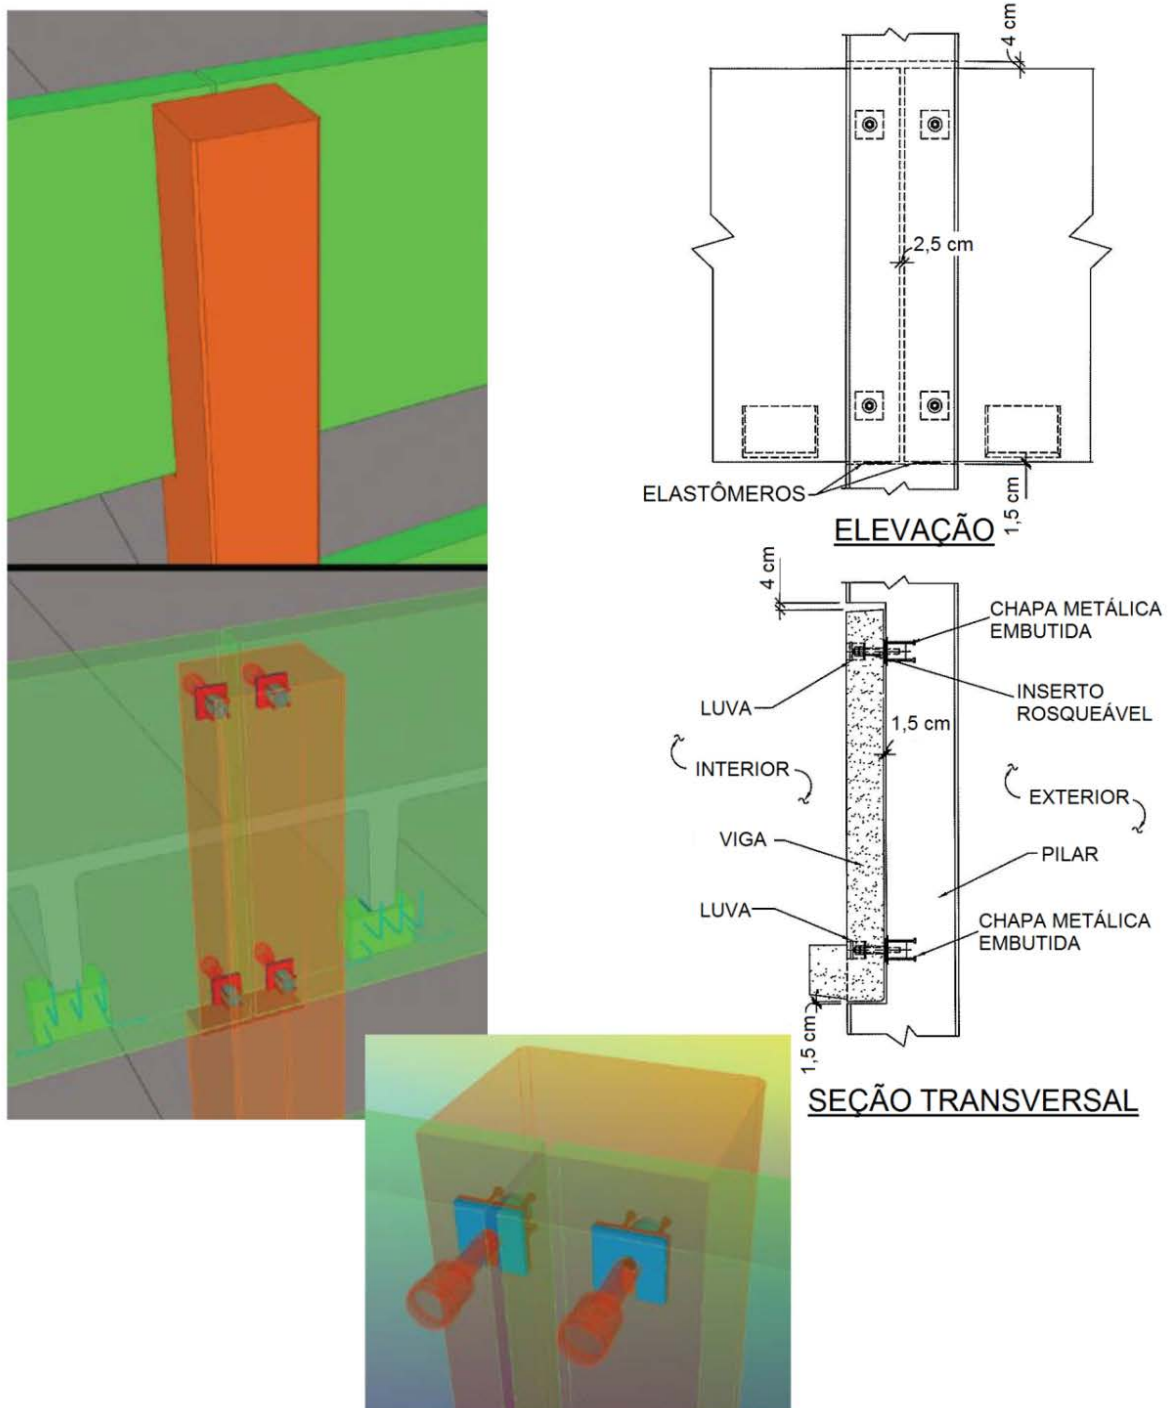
Ligação viga-pilar típica para vigas com peitoril alto e delgado sujeitas à torção no apoio, opção com pilar posicionado para fora do edifício [SHOCKEY, 2008].
